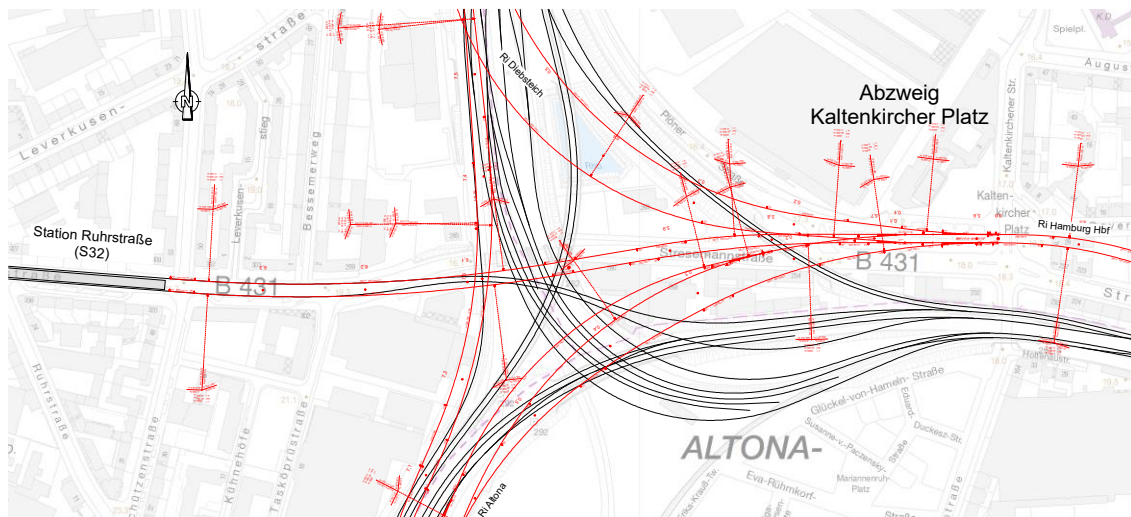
Lageplan Anschluss S32 bei Station Ruhrstraße
